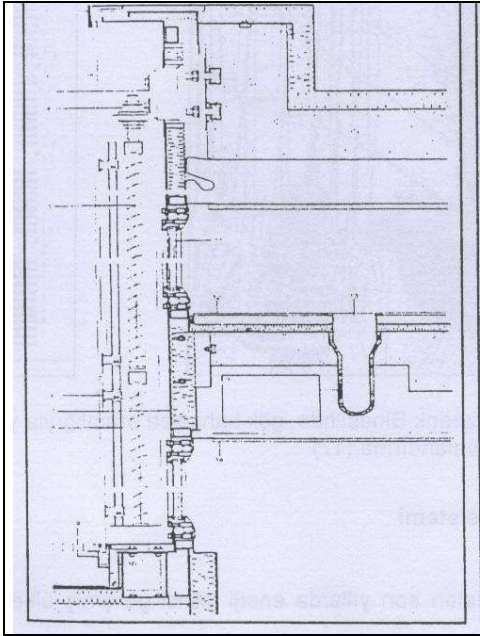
Çift kabuk cephe sistemleri havalandırma ilkeleri [49]
